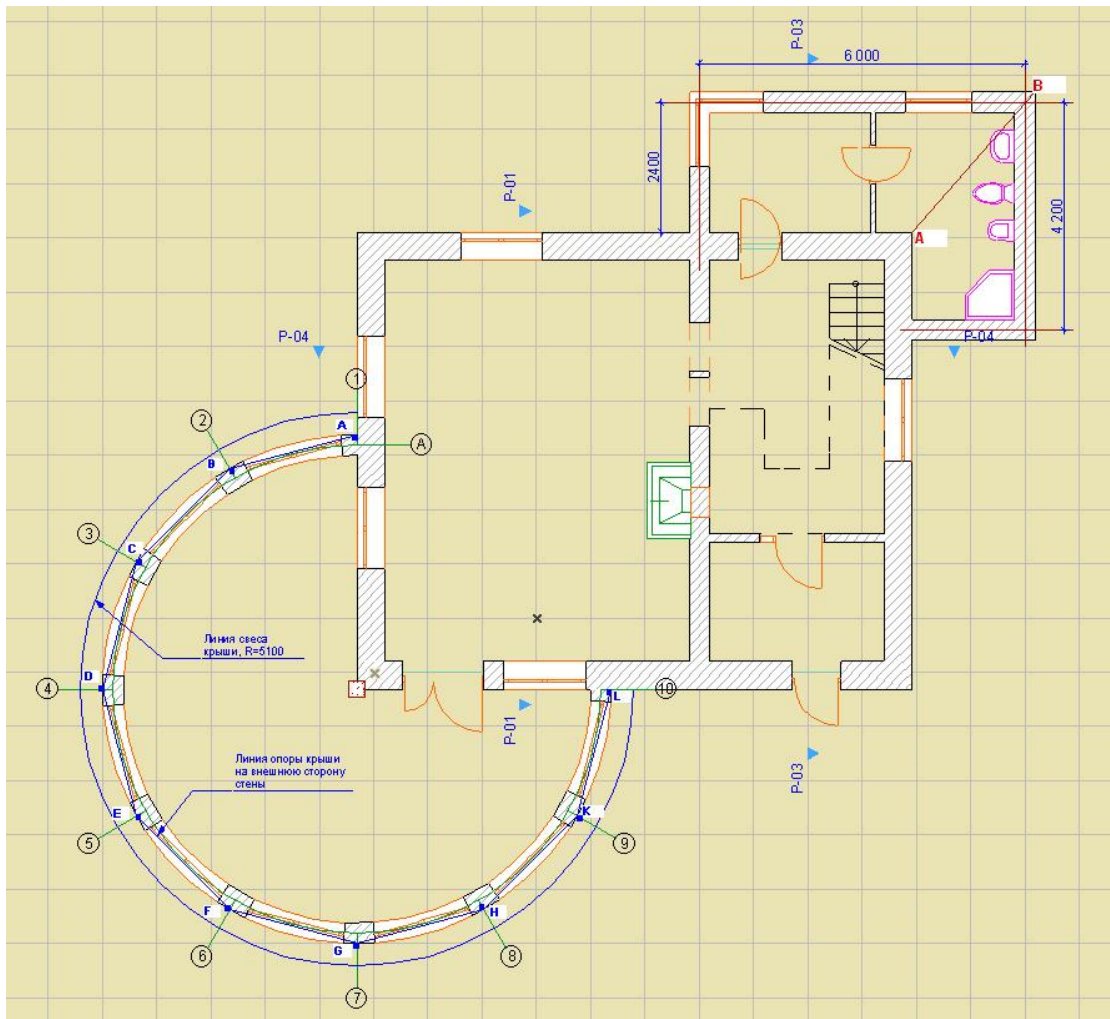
План первого этажа дома с достроенными хозблоком и верандой.
